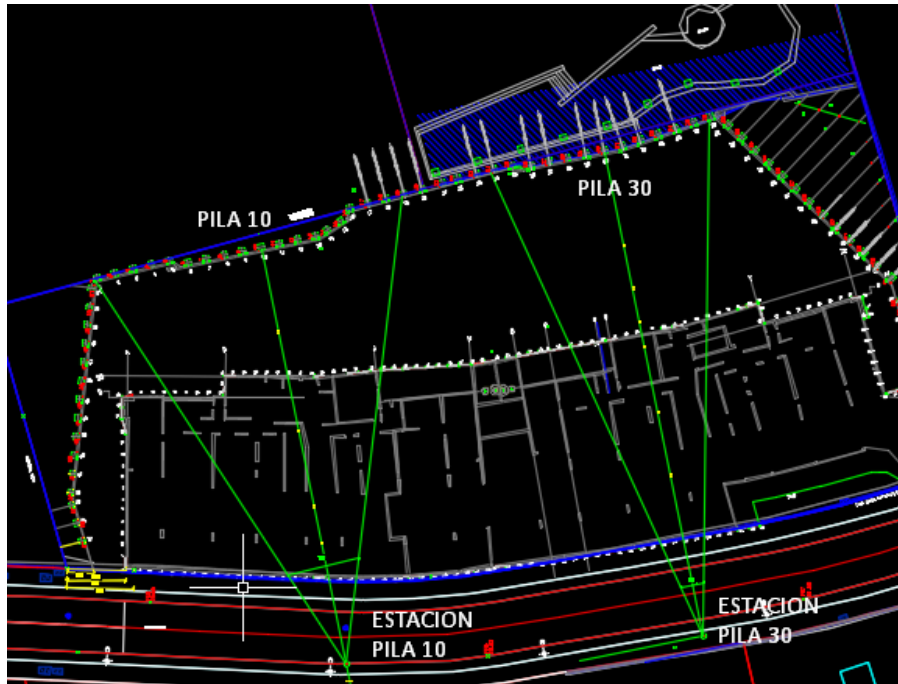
Vista en planta sección Transversal Pilas 10 y 30.
